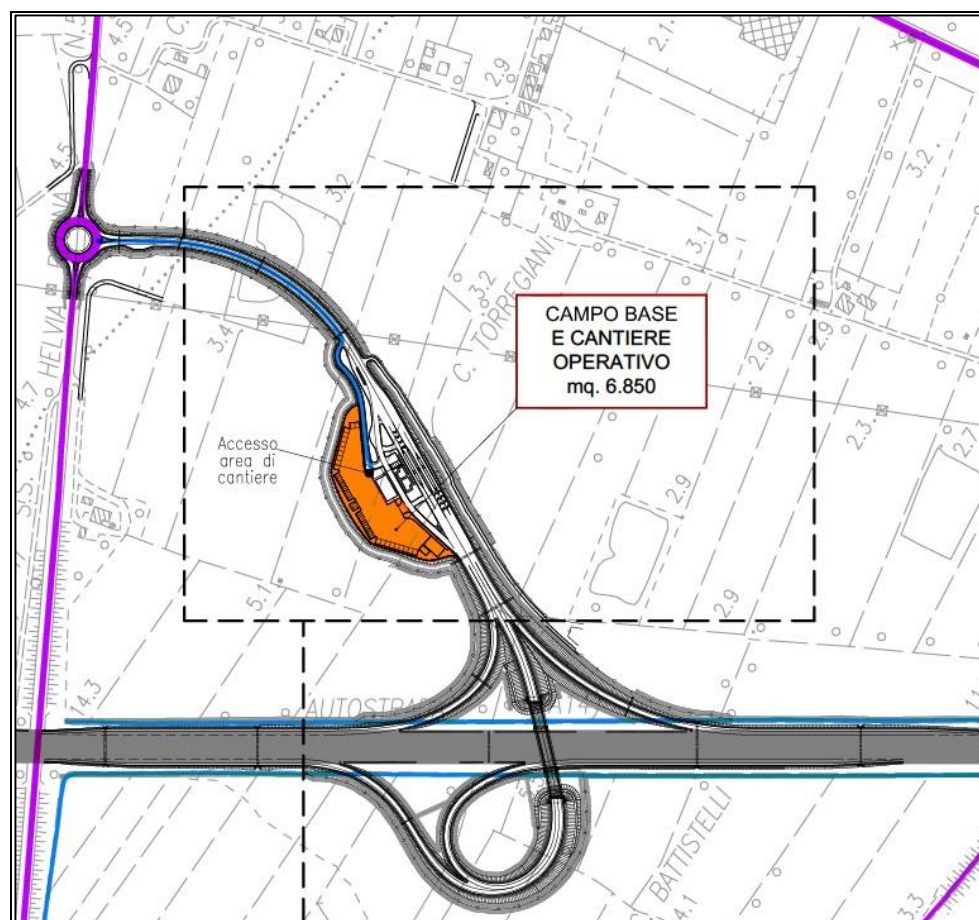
estratto planimetria del campo base-cantiere operativo
